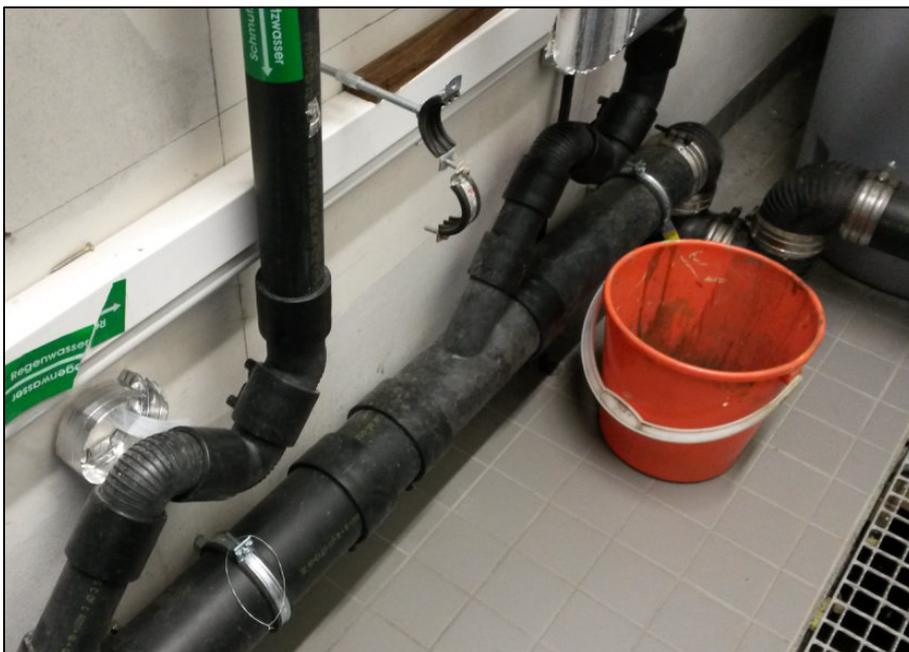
Abwasserleitungen im Hausanschlussraum (0.18)
